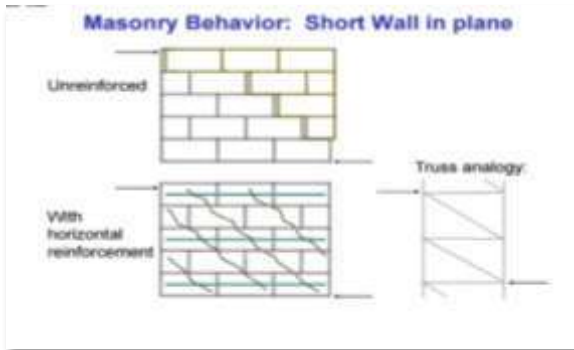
Comportamiento de mampostería mampostería dentro del plano
